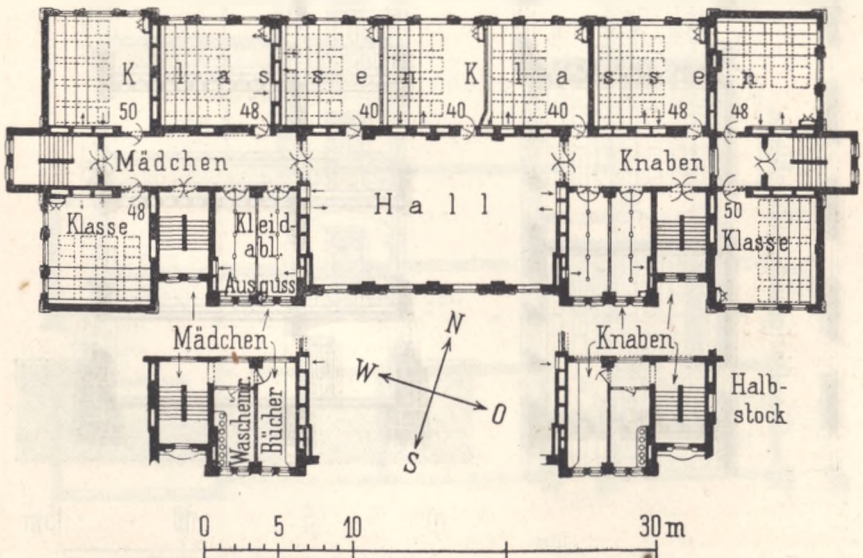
Grundriß des Erdgeschosses der higher grade school, Cassland road, London, nach Bailey.
